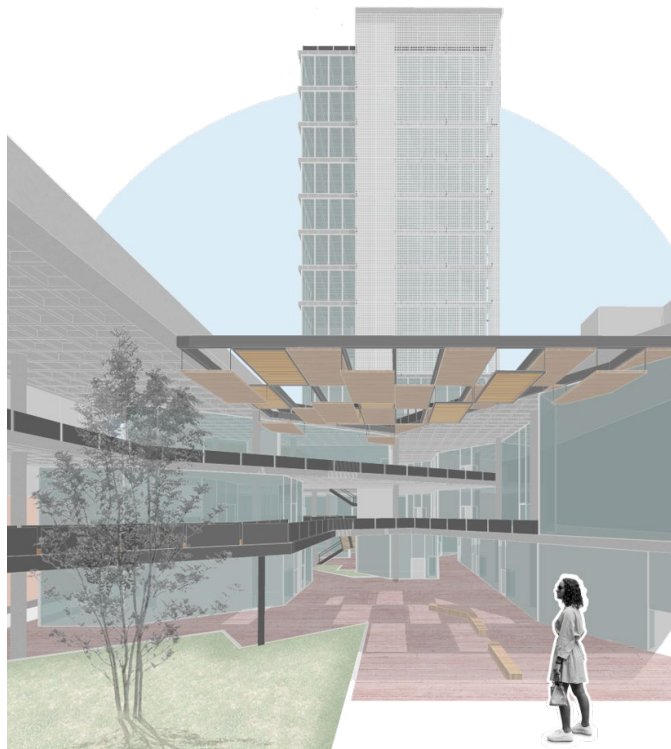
Pátio central e lajes movimentadas / Fonte: Autoria do grupo
